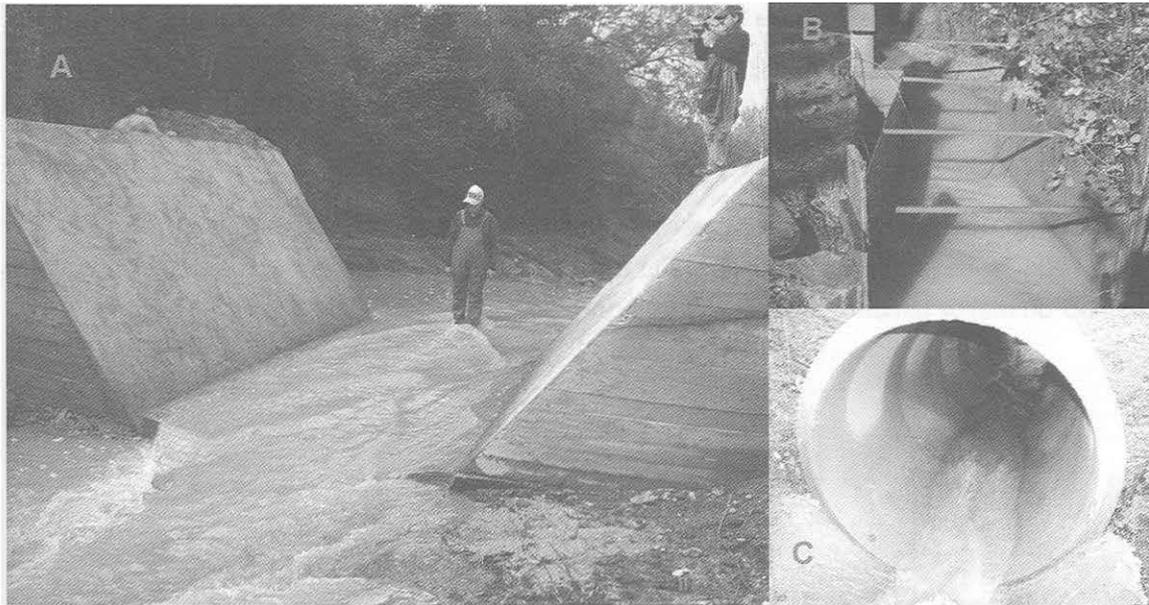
Estructuras de Aforo: a) Canoa Santa Rita (725 ha) b) Canoa de Fondo Plano (16 ha) y c) Ducto Circular (42 ha).
